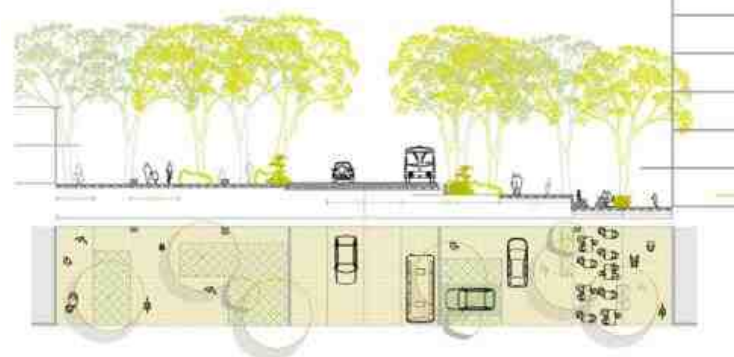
Profil en travers proposé au droit de la future voie structurante
